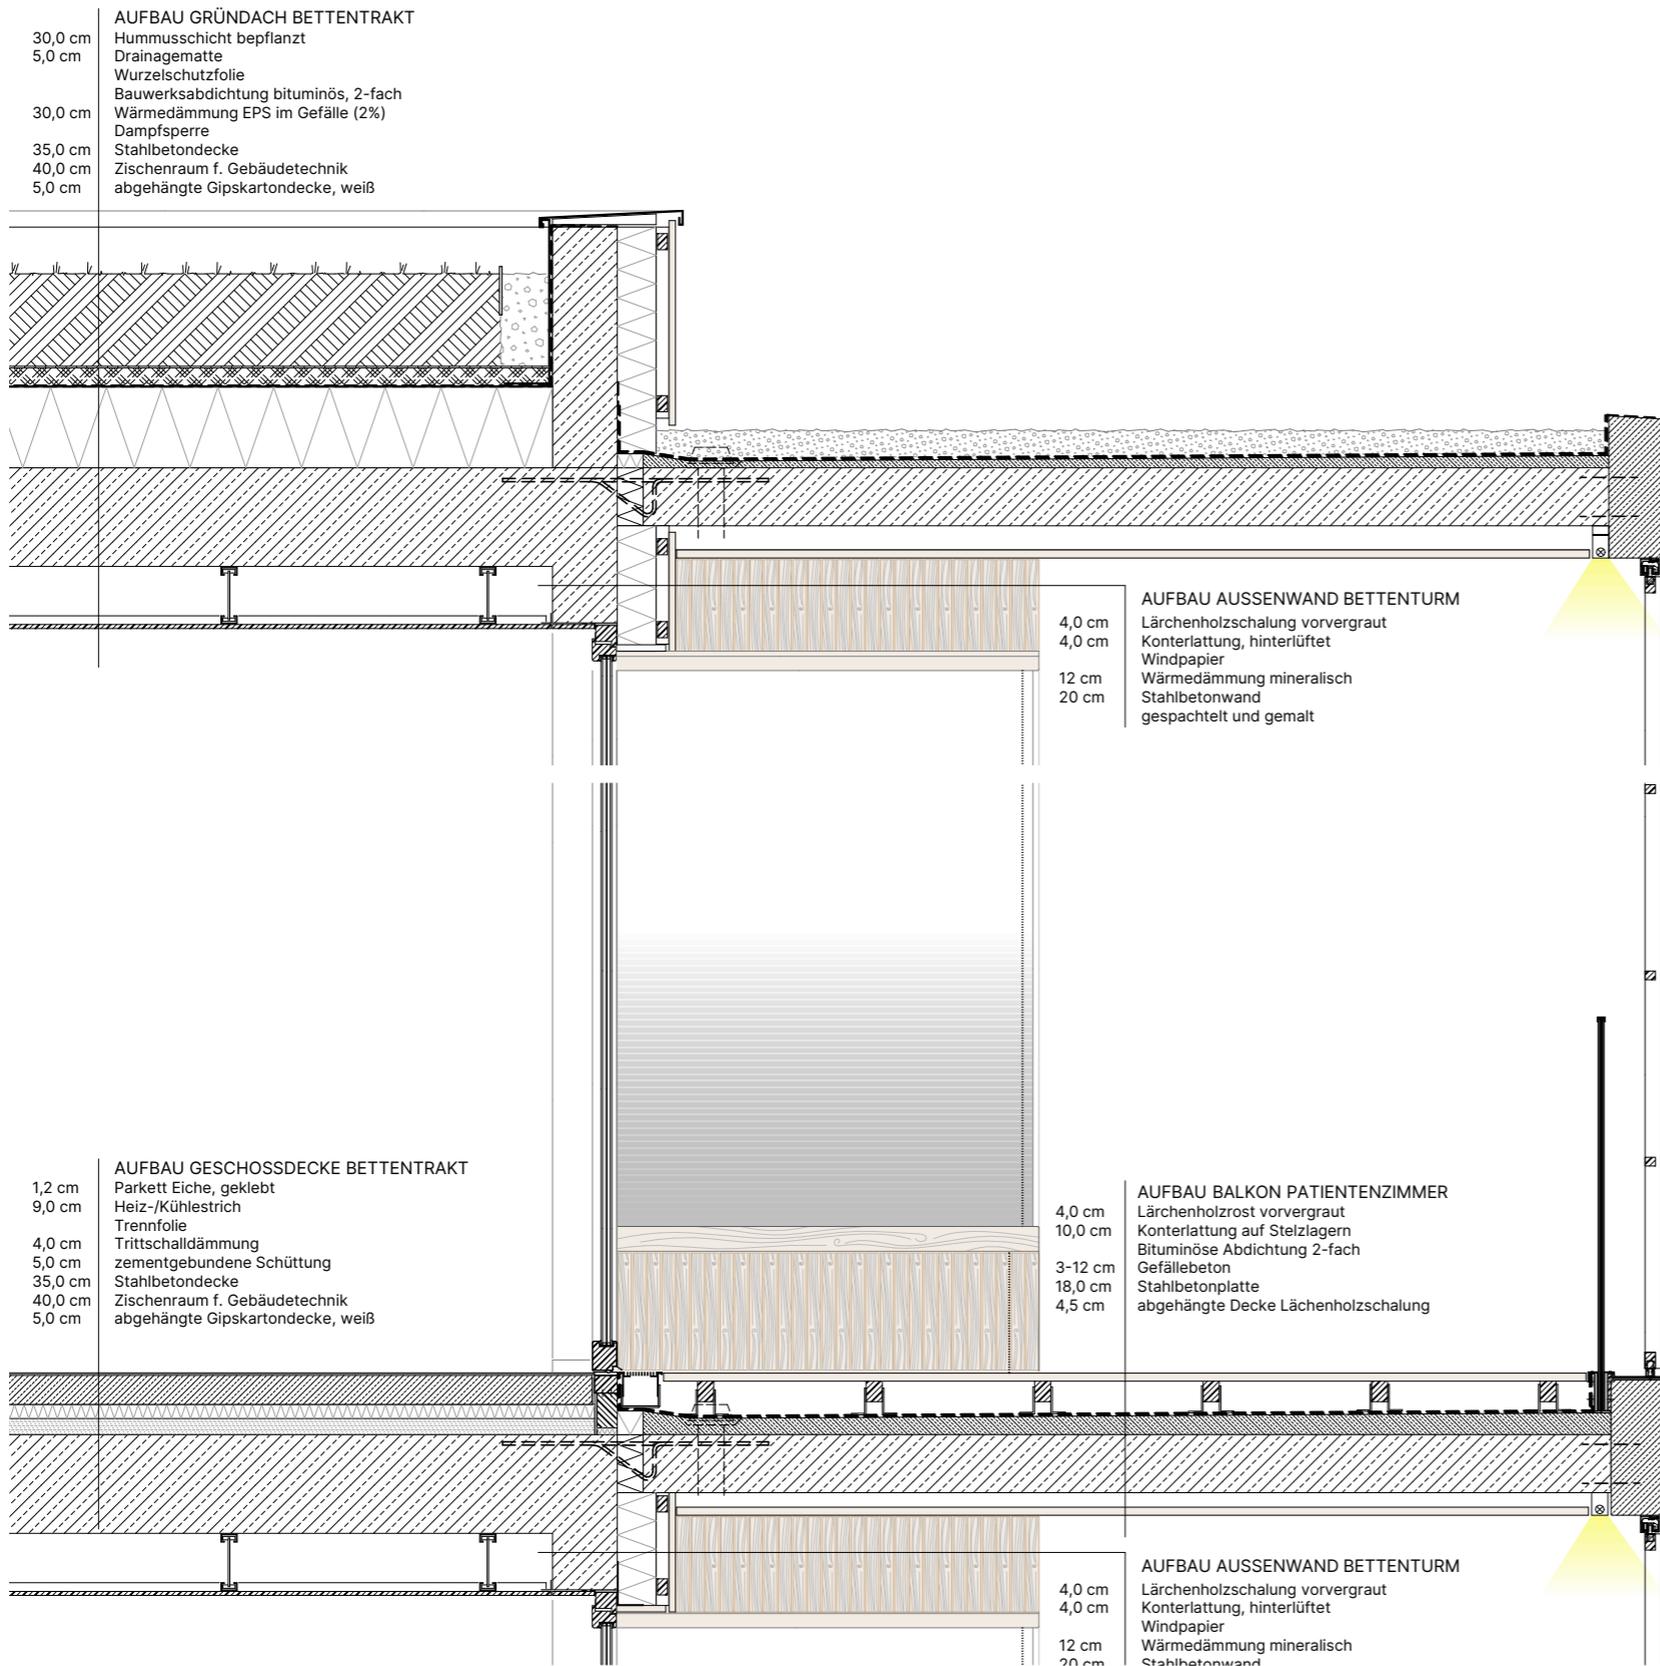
Fassadenschnitt OG 3 - Bettenturm
